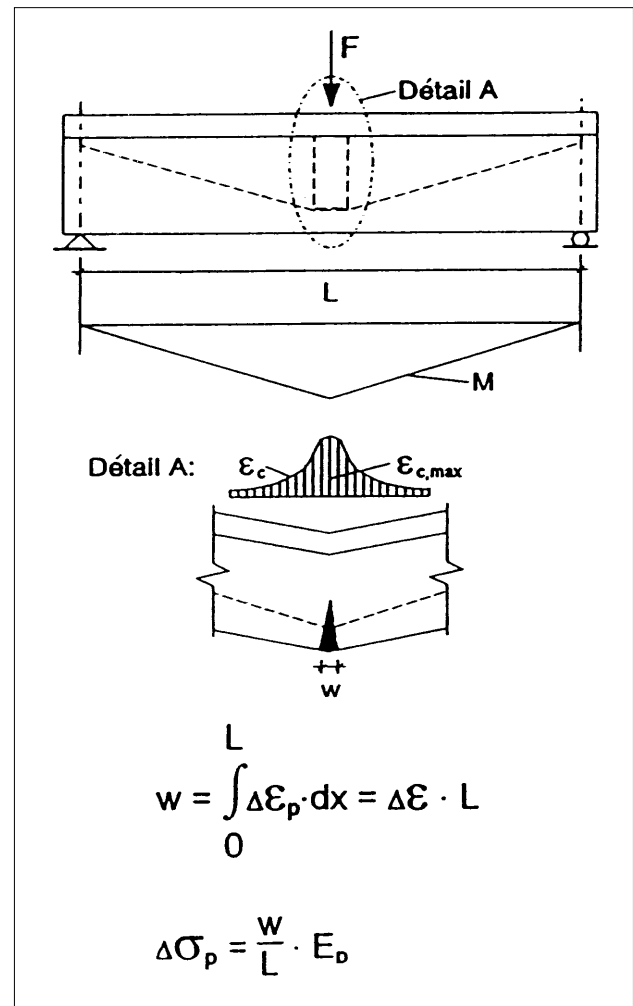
Poutre avec précontrainte extérieure après le dépassement de la charge de fissuration.
